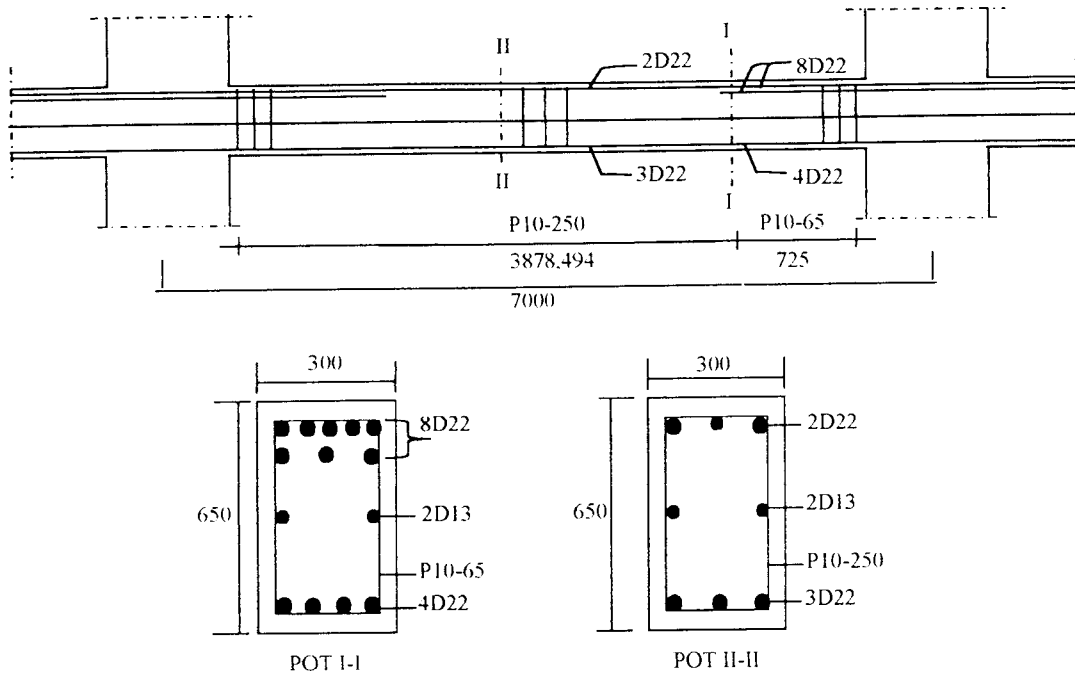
Balok Portal E Bentang 7 m Lantai 4
